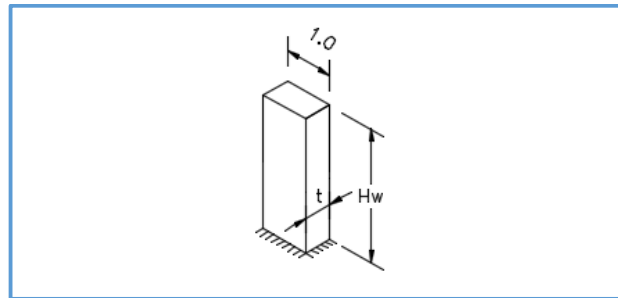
Modelo del muro como viga en voladizo con ancho 1.00 m
